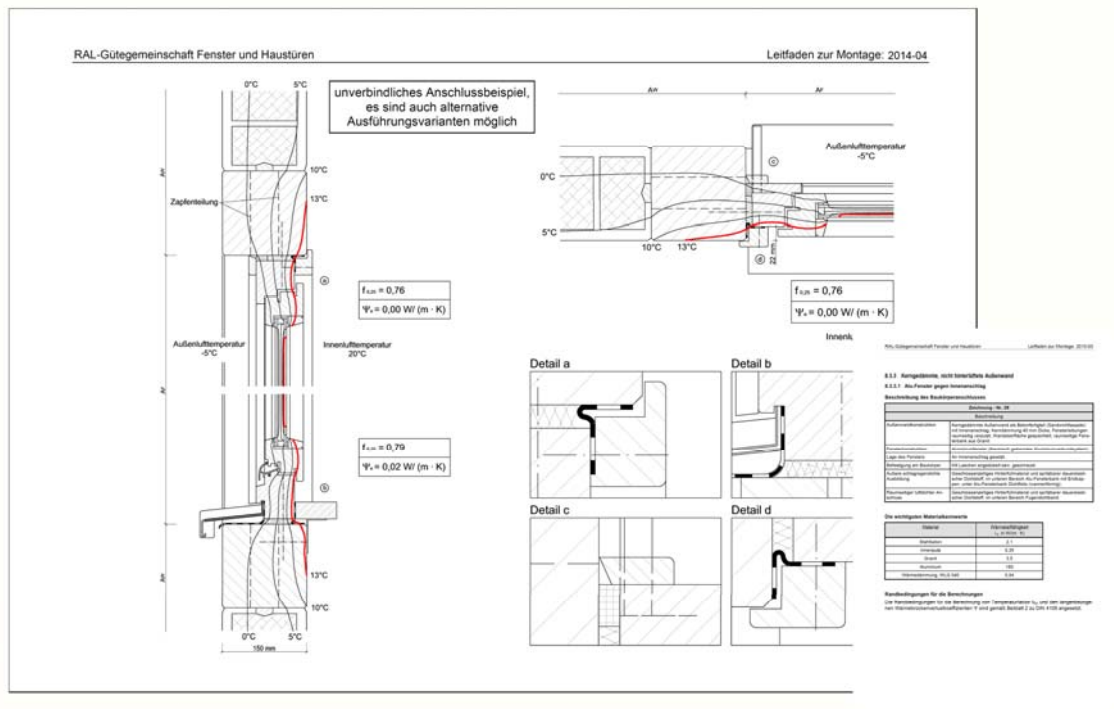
Ausführungsbeispiel inkl. Kennwerten für eine Fenstermontage in kerngedämmter, nicht hinterlüfteter Außenwand mit Beton-Sandwich-Elementen (Auszug aus Montageleitfaden)
